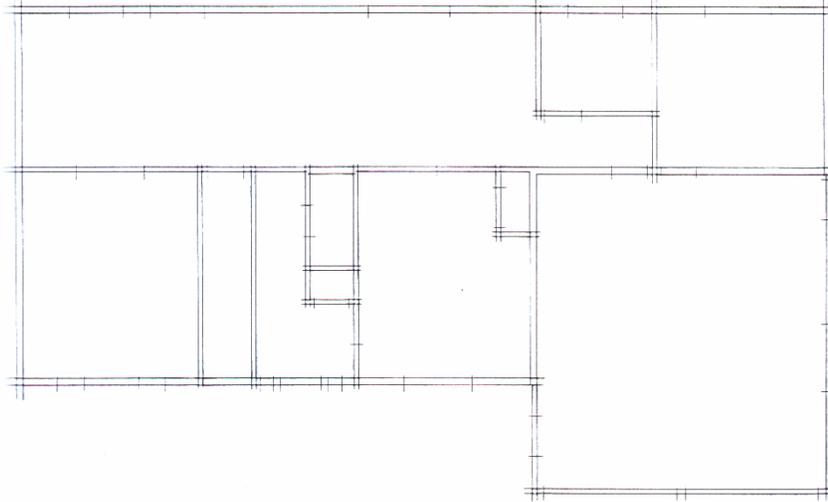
المسقط الأفقي الناتج عن مستوى القطع الأفقي المار بالمبنى
